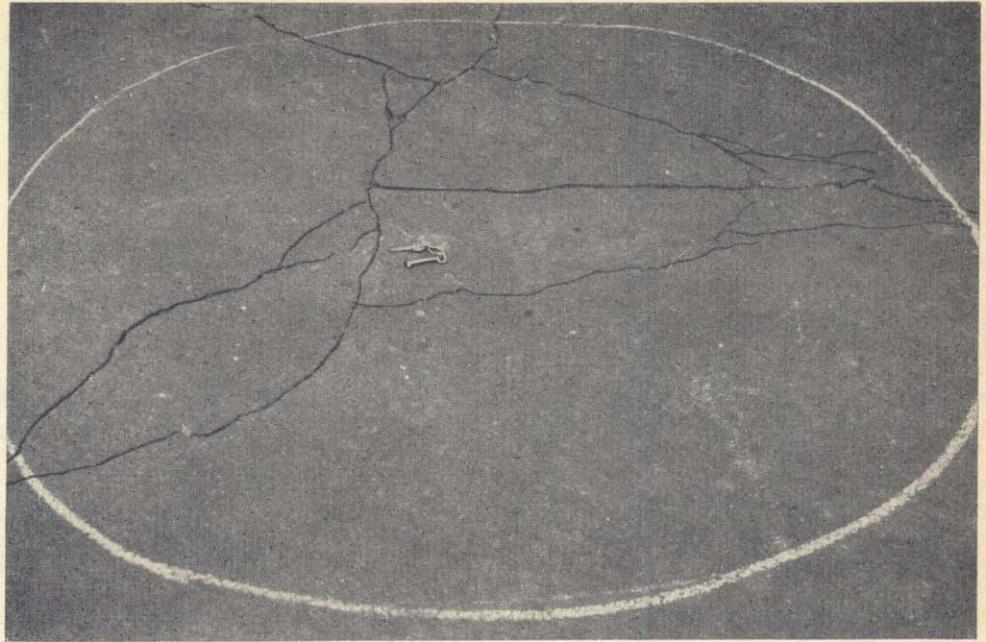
a — Fisuras debidas a la contracción de la carpeta.
